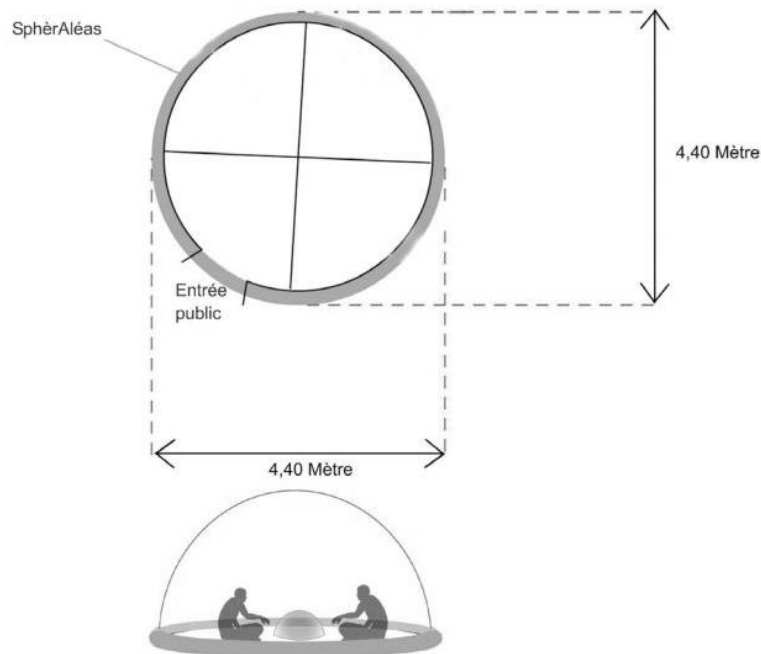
Plan et coupe de l'installation SphèrAléas.
